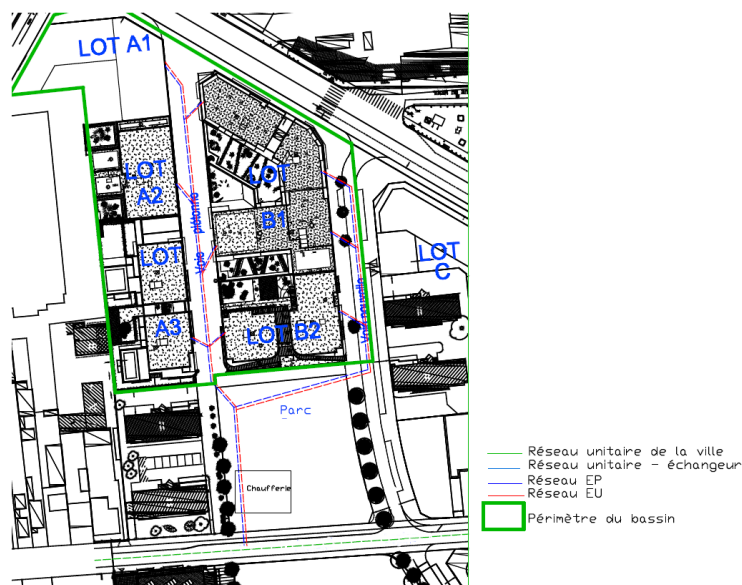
Extrait de plan des réseaux, plan extrait de source [4]
